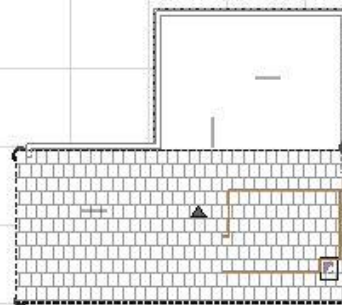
Planta Cubierta. Tomado de Fénix Construcciones.
